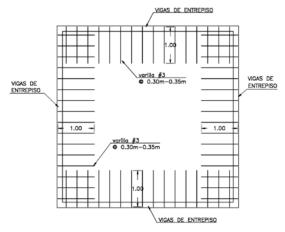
Vista en planta de refuerzo sísmico de entrepiso
